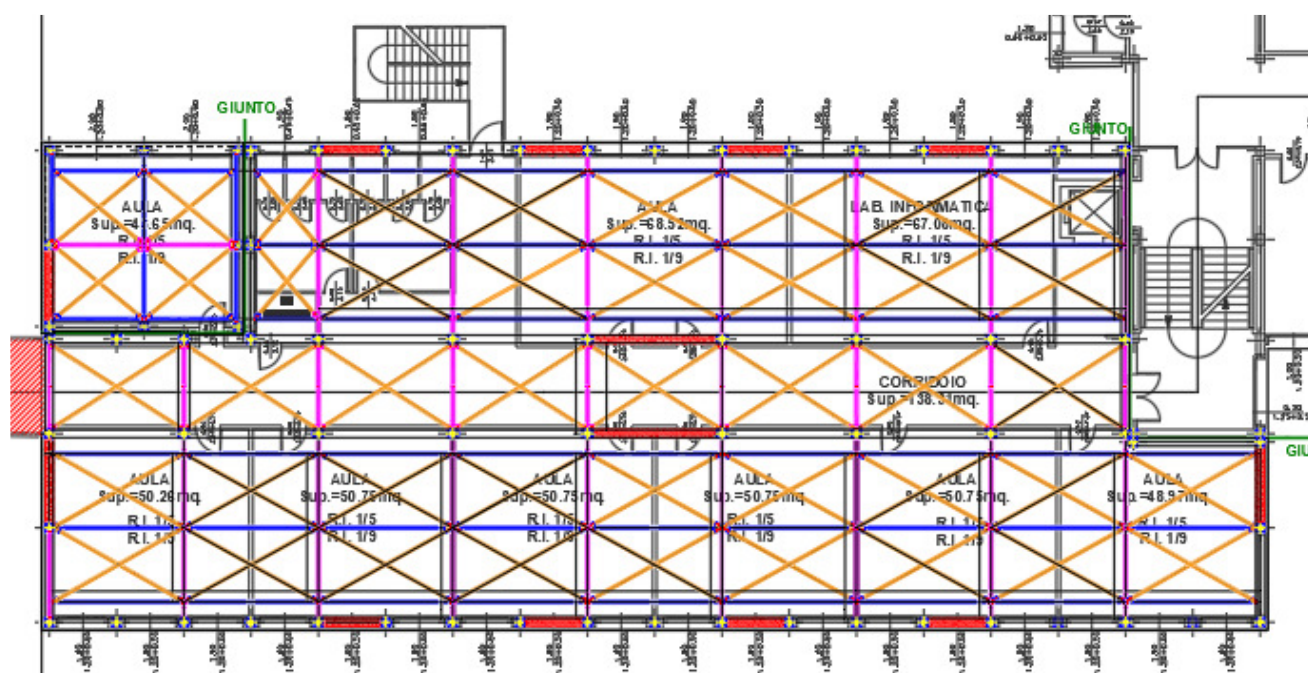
Lavori strutturali LOTTO 2 – piano primo
